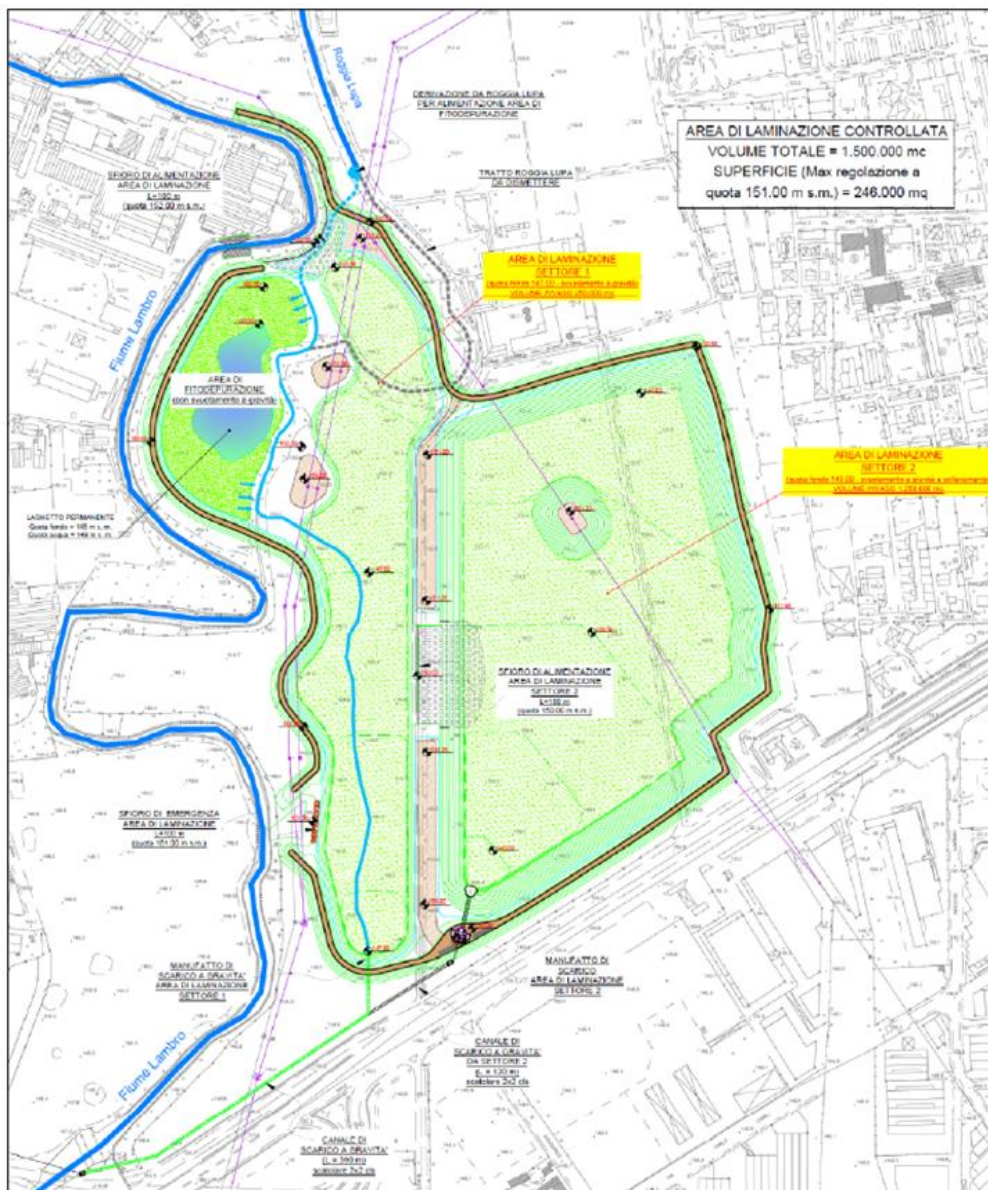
Planimetria dell'area di laminazione in Monza, loc. Cascinazza
